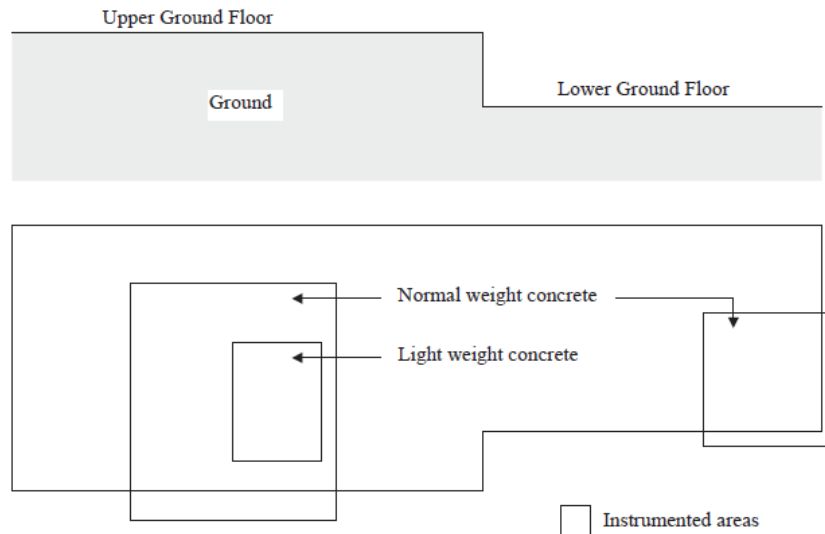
The west building, planimetria e sezione (Adjali, Davies, & Rees, 2004)
